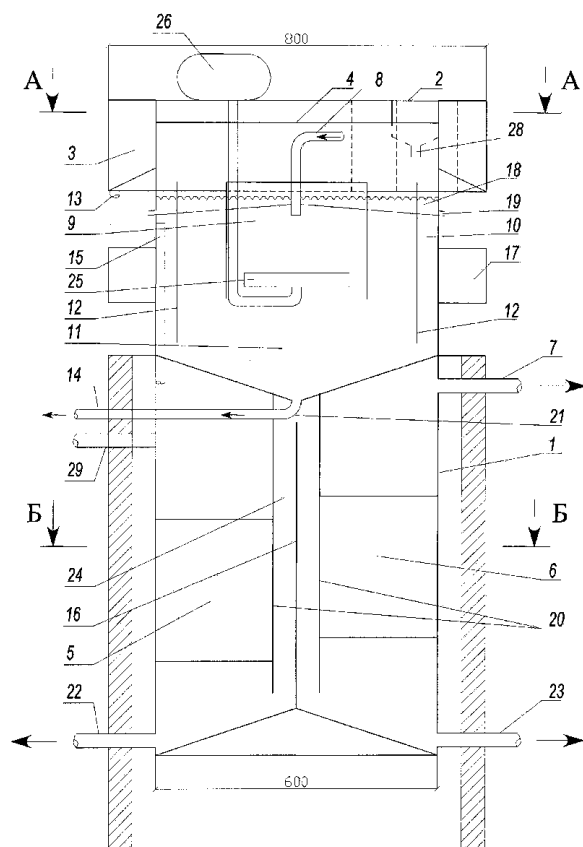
Компоновка очистных сооружений (вид сбоку)
